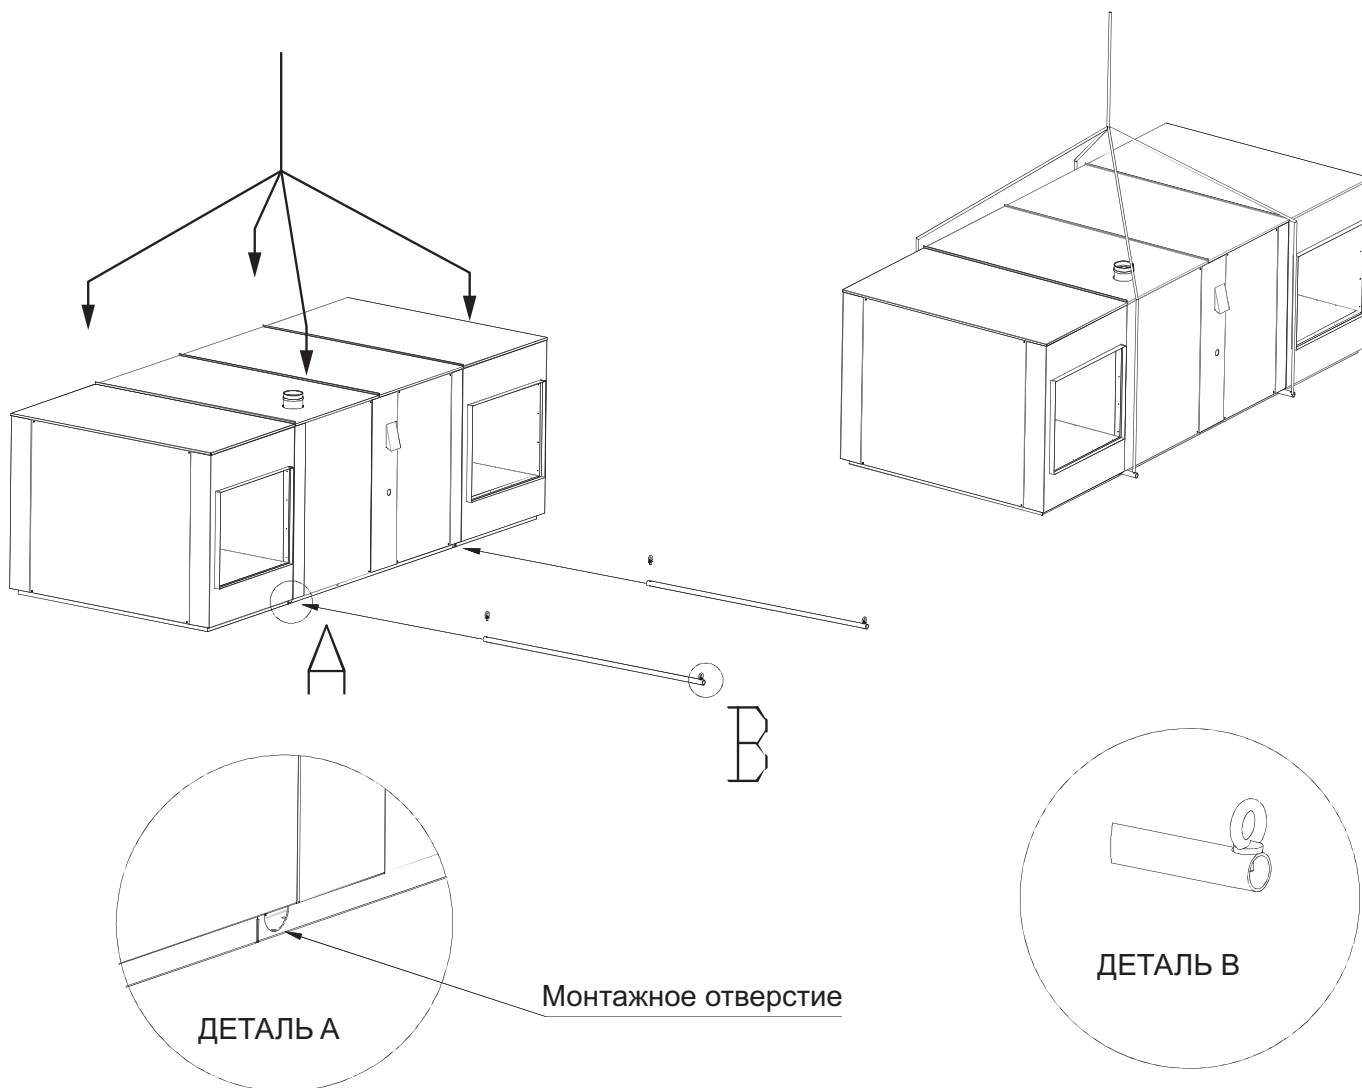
Схема подготовки погрузки/разгрузки нагревателей EOLO B RT
